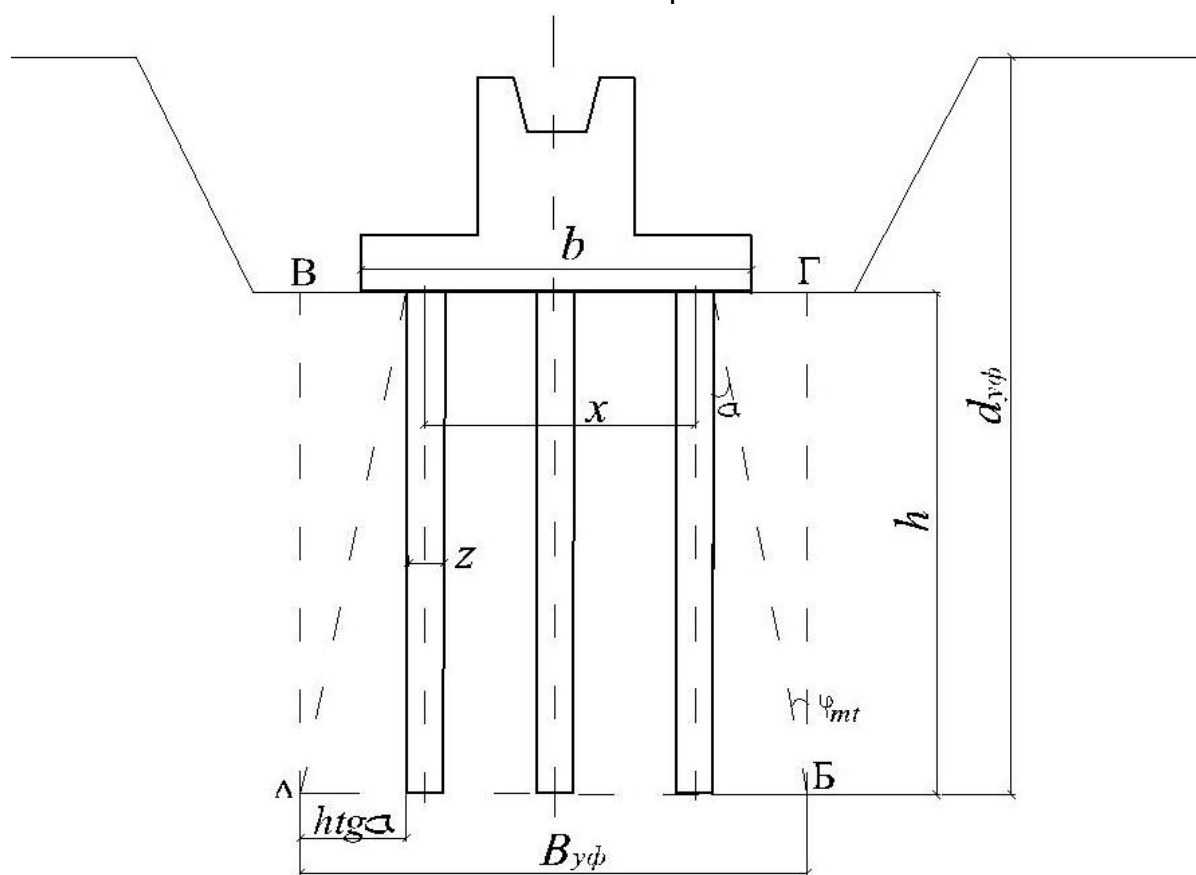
Расчетная схема свайного фундамента по деформациям
